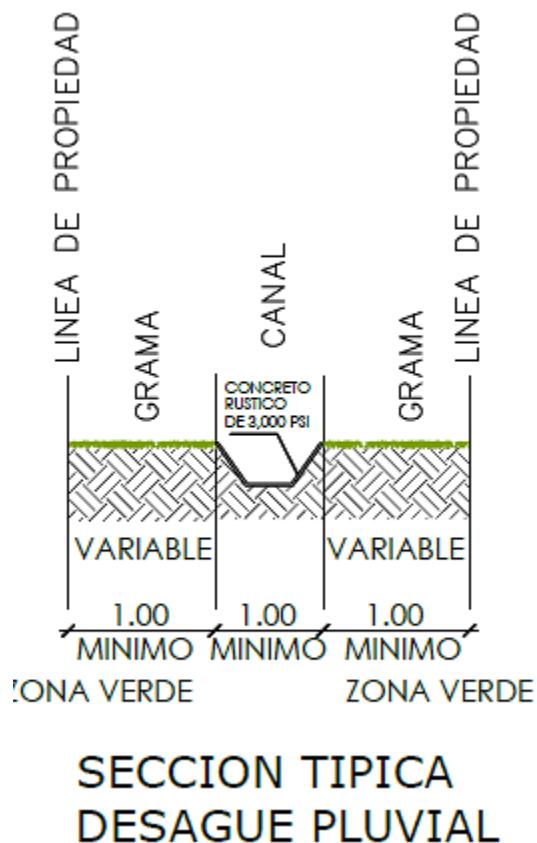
Detalle. (Sección). Desagüe Pluvial. Fuente: Planos del proyecto, 2022
